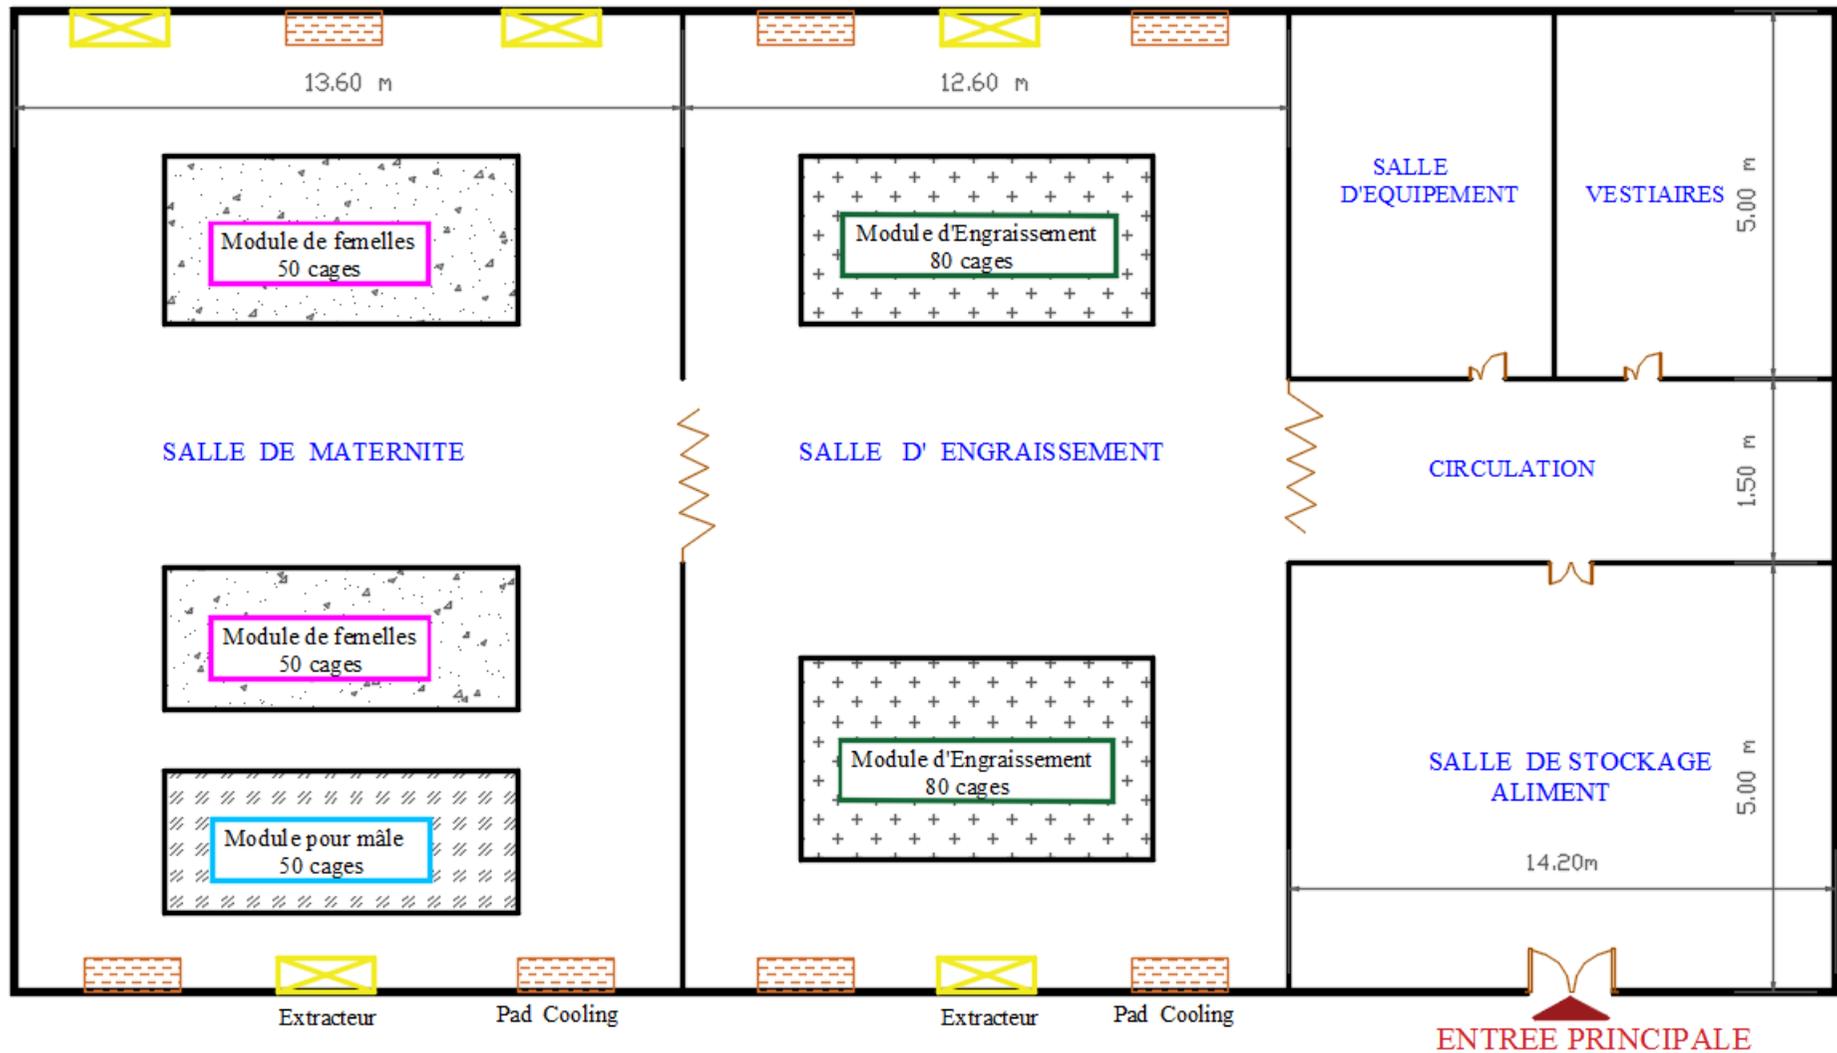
Plan du clapier de l'Institut Technique d'Elevages.
